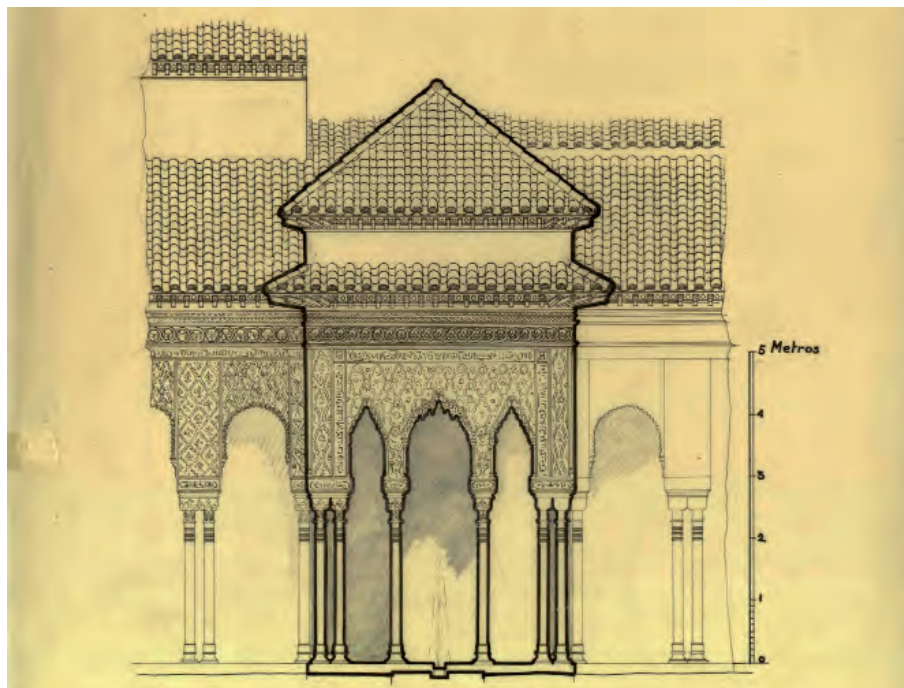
Detalle de columna, imposta y armadura de madera. Fuente: Archivo del Patronato de la Alhambra.
